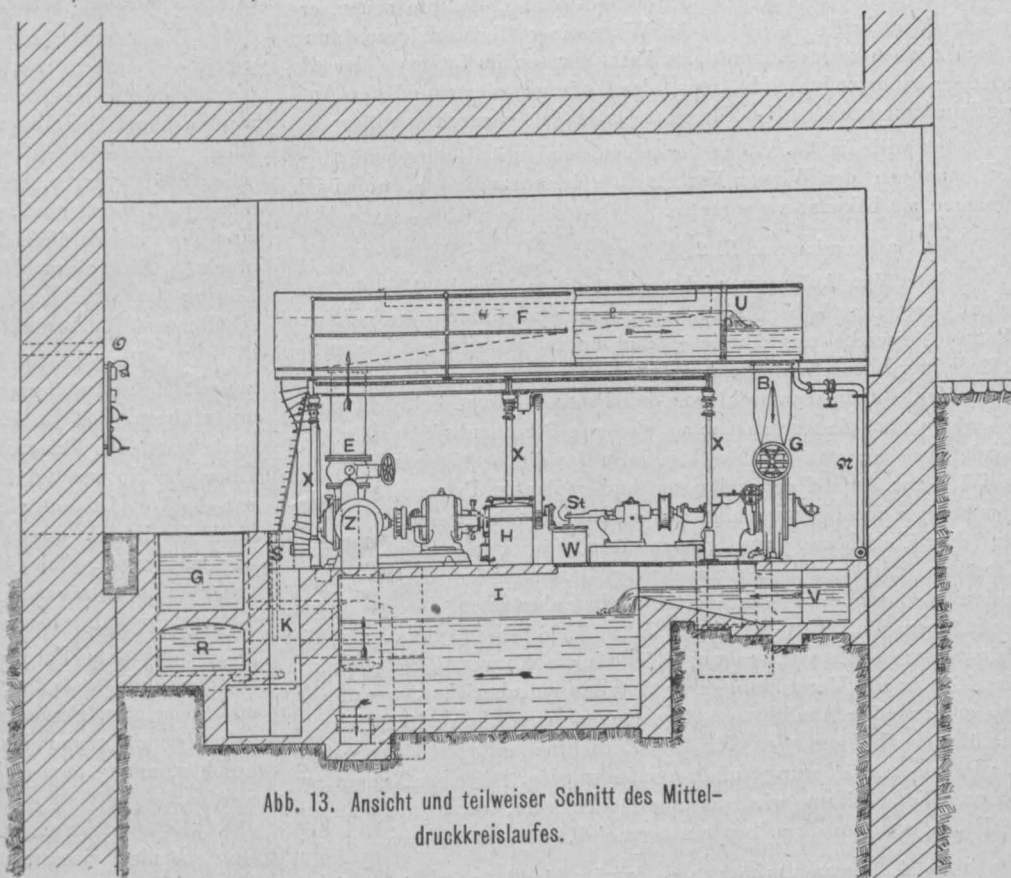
Ansicht und teilweiser Schnitt des Mitteldruckkreislaufes.
